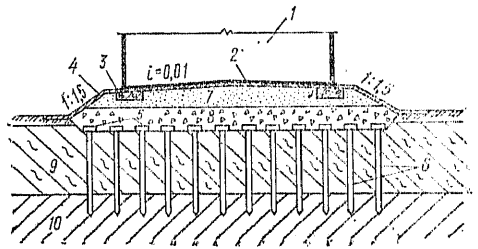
Резервуар на свайном фундаменте с промежуточной подушкой
